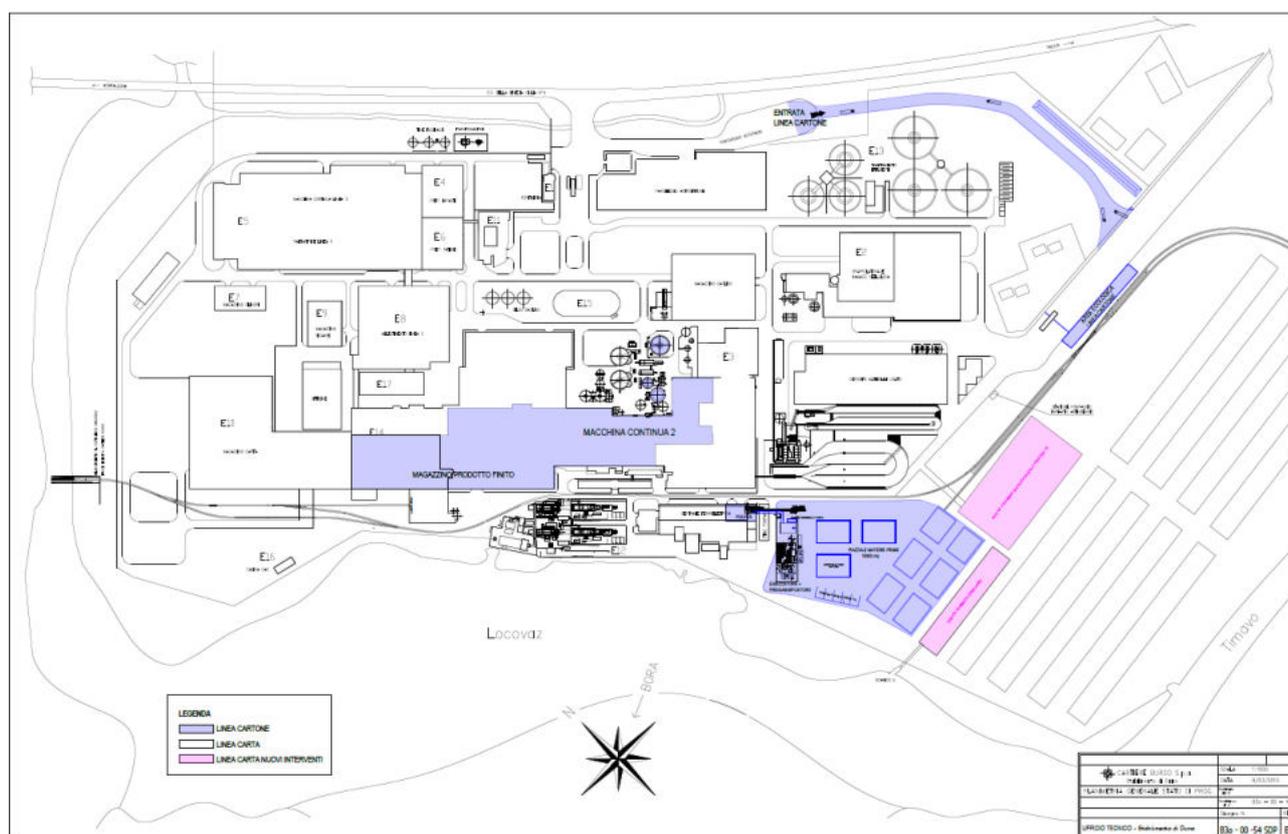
planimetria dello stabilimento Cartiera del Timavo.
